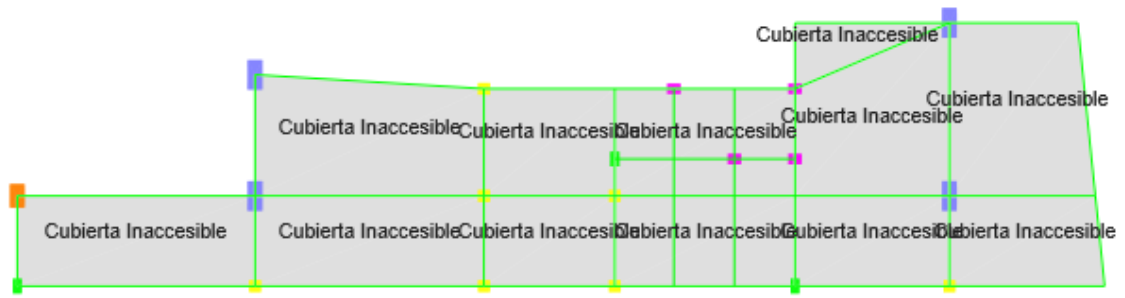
Carga Cubierta Inaccesible N+64.24
